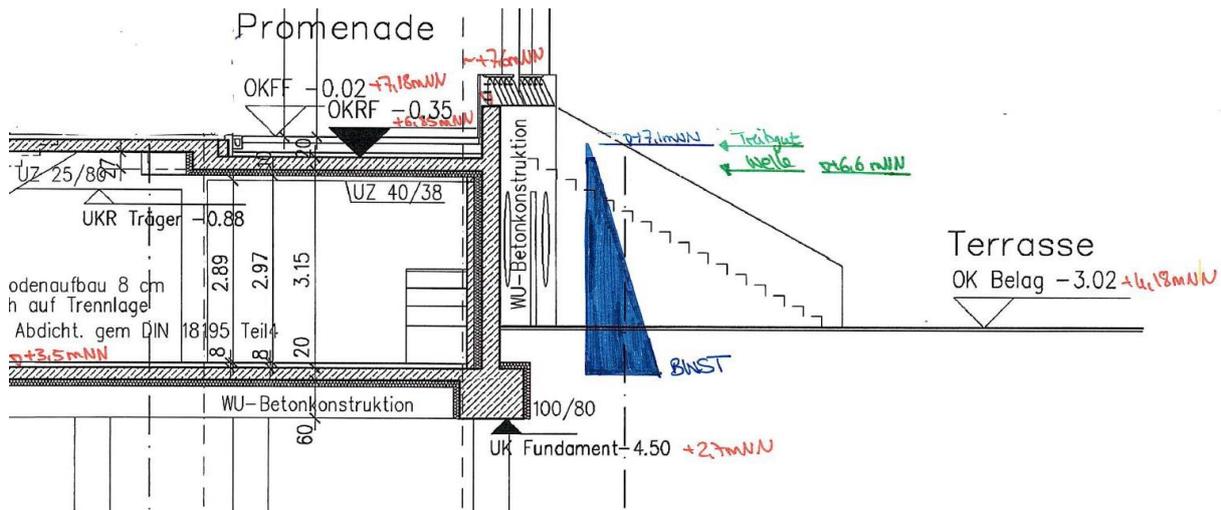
Belastungsbild Kellerwände – veränderter Ausschnitt aus dem Plan 552 (Stand: 07.03.2001)
